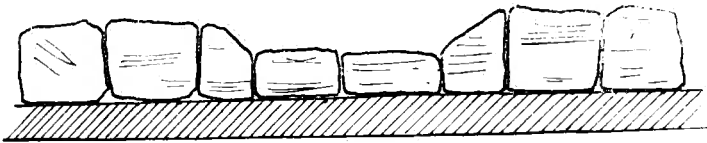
Dallage d'Api. Coupe (restituée) du « dispositif en croix ».
